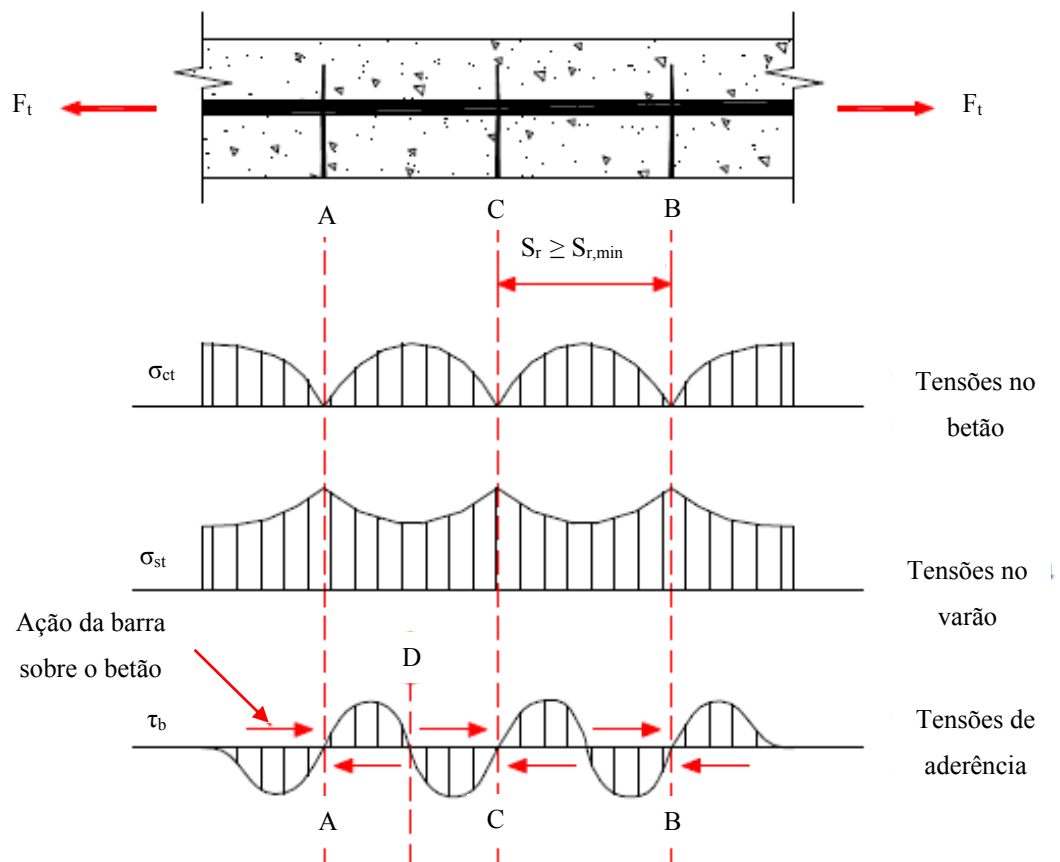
Fissuração estabilizada - Leonhardt, F. e Monnig, E [30]
